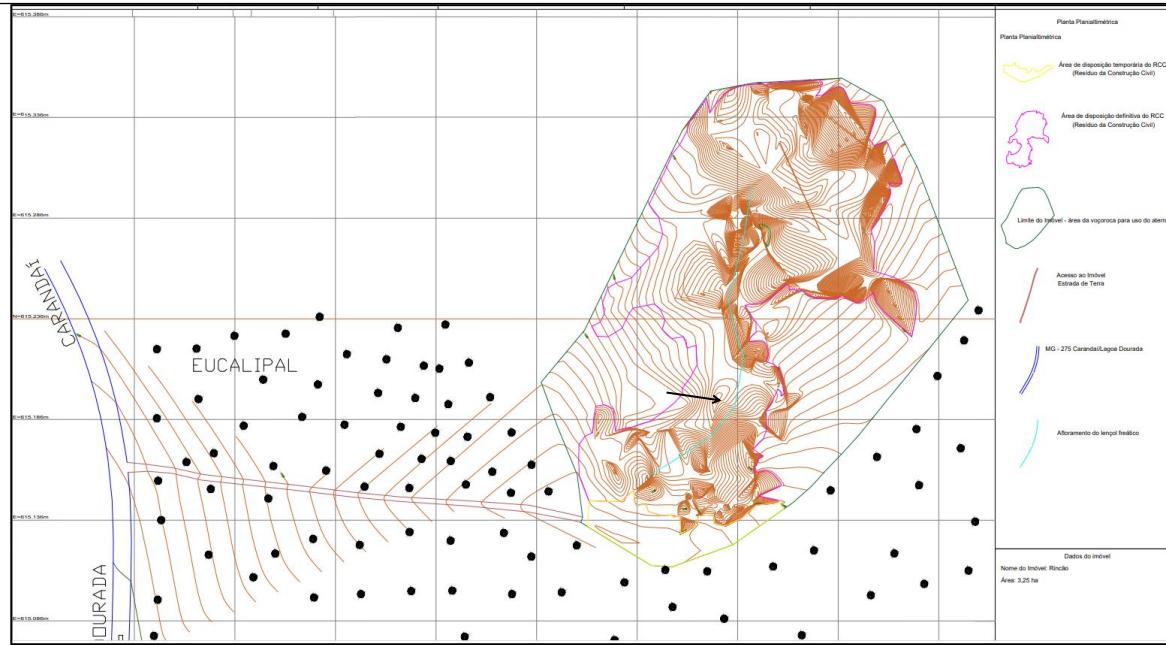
Planta planialtimétrica da propriedade. FONTE: Processo SLA nº 4868/2021
